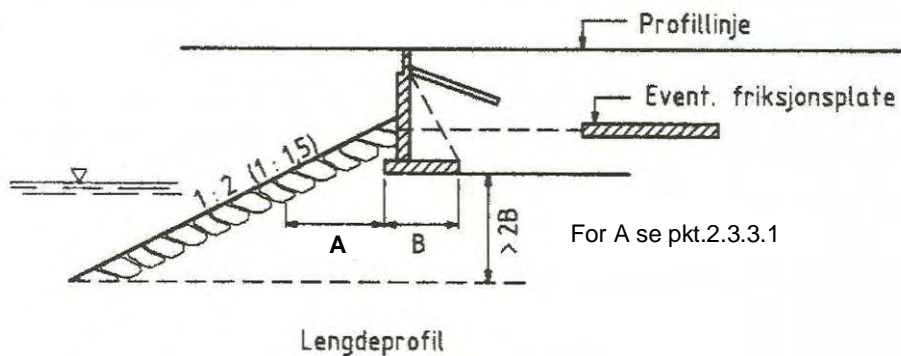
18 Fyllingsdimensjoner jar brulandkar, lengdeprofil
